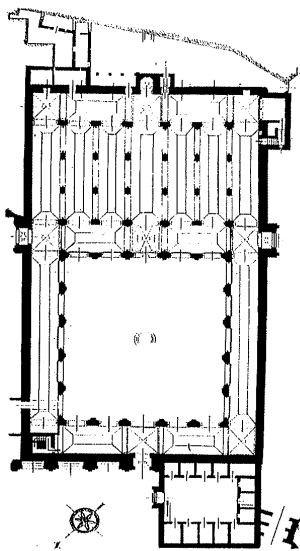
مسقط أفقي لجامع الاندلس بفاس
